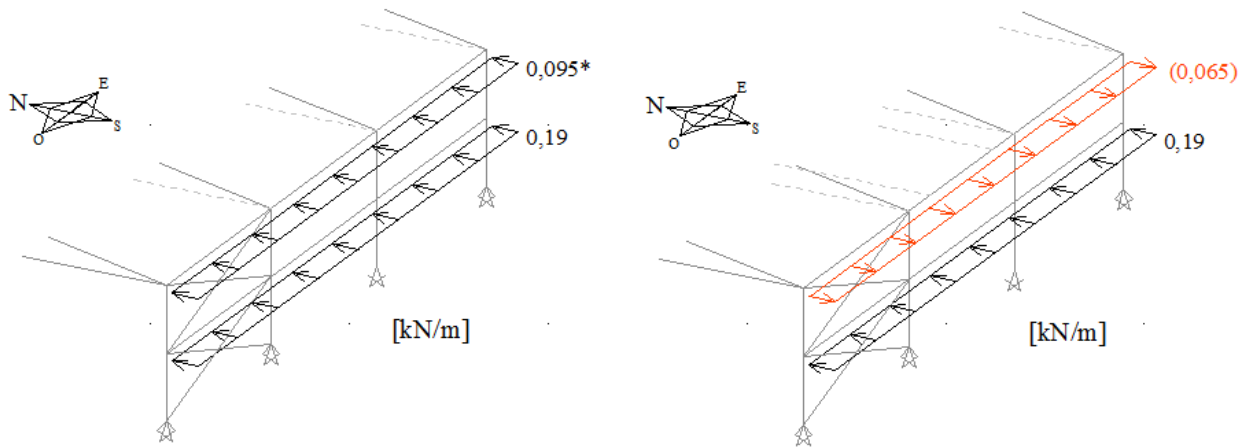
Vento W1 na fachada orientada a Sul na situação 1 (RSA)
